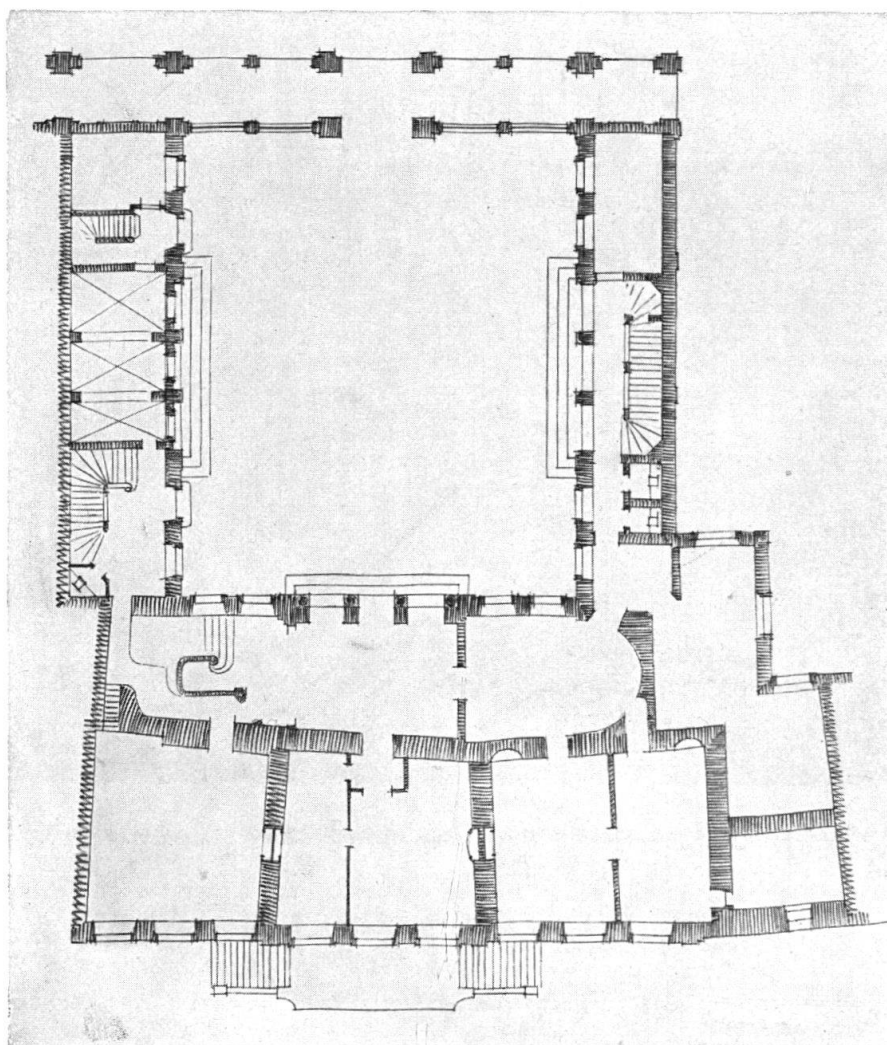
Heutiger Grundriß mit dem eingeschöfigen Laubtrakt.
